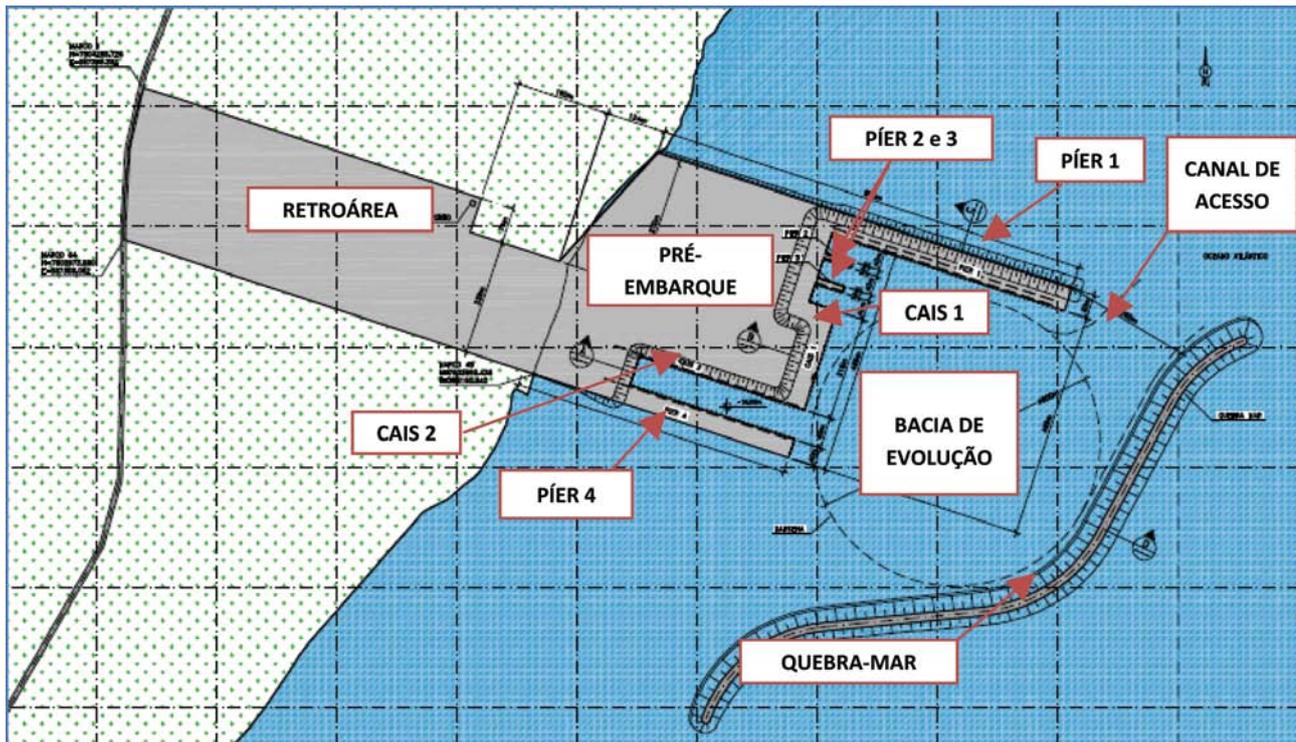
Detalhe das estruturas previstas para o Terminal Industrial IMETAME.
